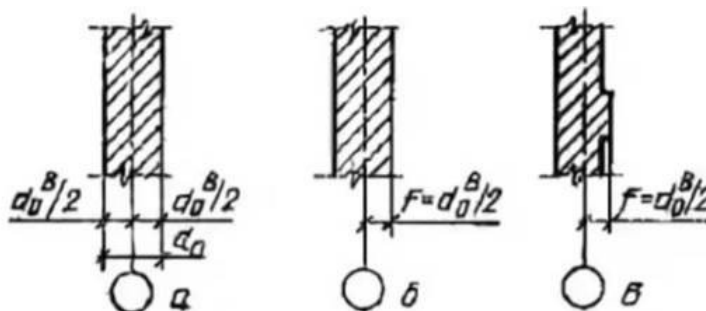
Рекомендации по назначению привязки стен: а – несущие наружные стены; б – внутренние стен; в – ненесущие наружные стены
